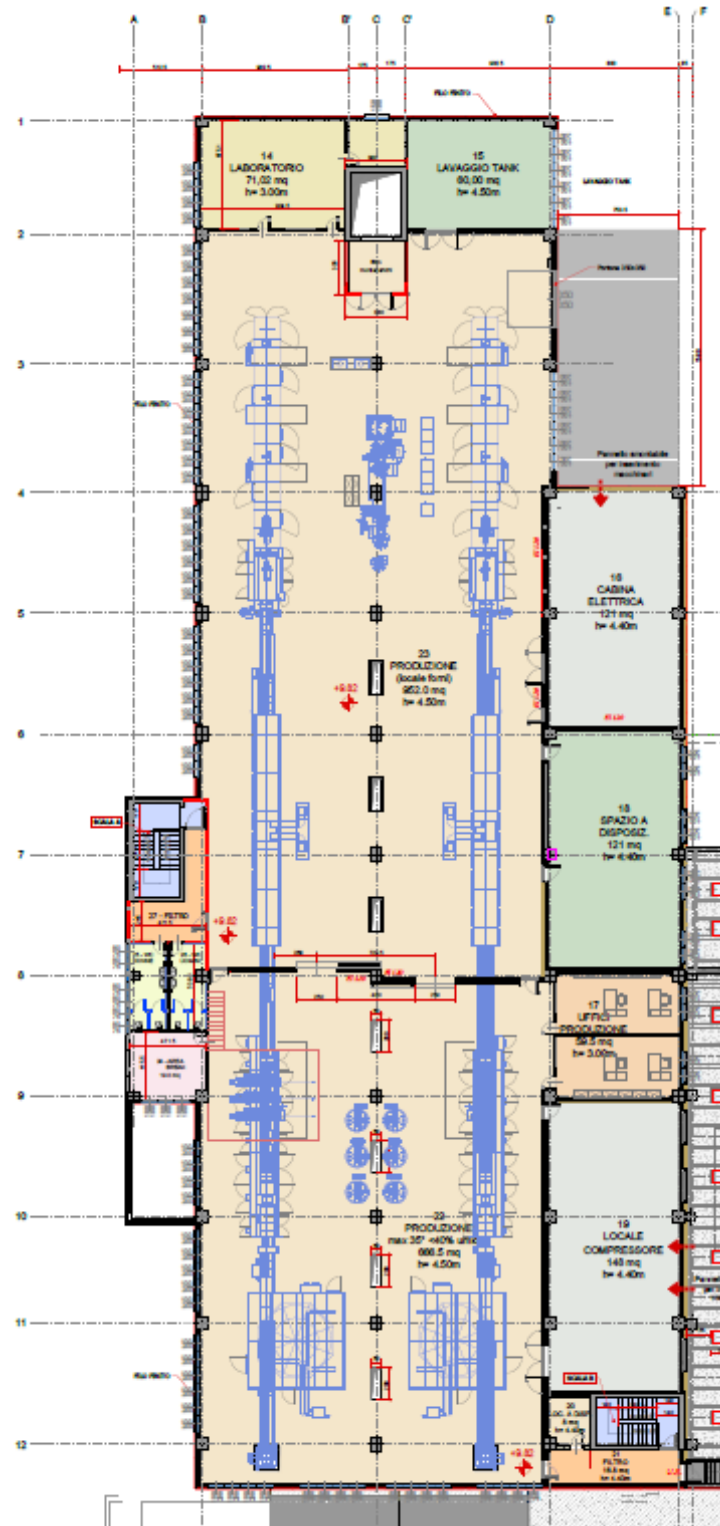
Planimetria architettonica piano P2 - Fabbricato Ex. Piemonte
